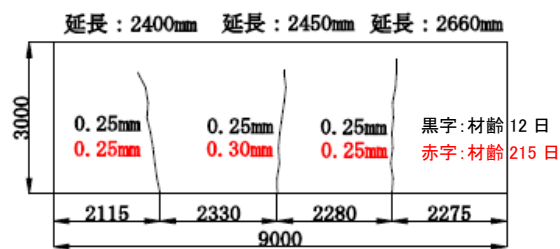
ひび割れ発生状況 (2 リフト目) ²⁾
